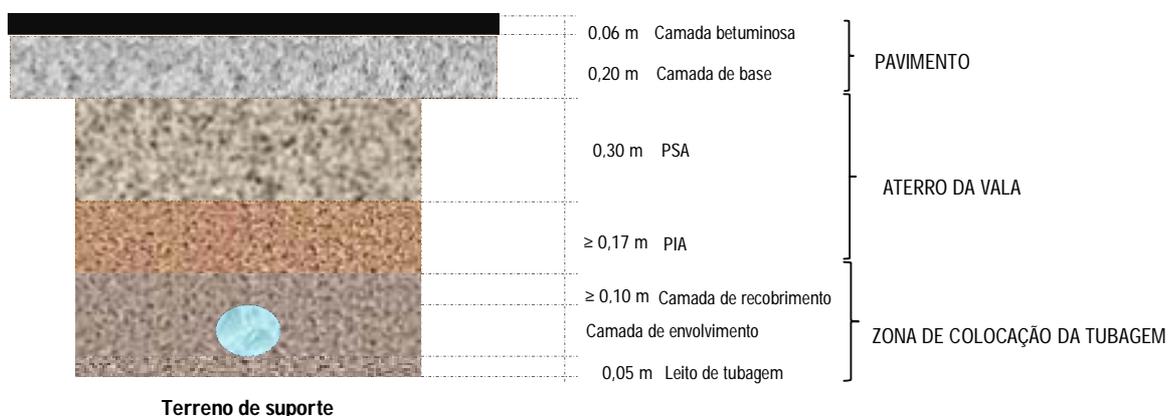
Caso tipo I: Valas essencialmente sob pavimentos
